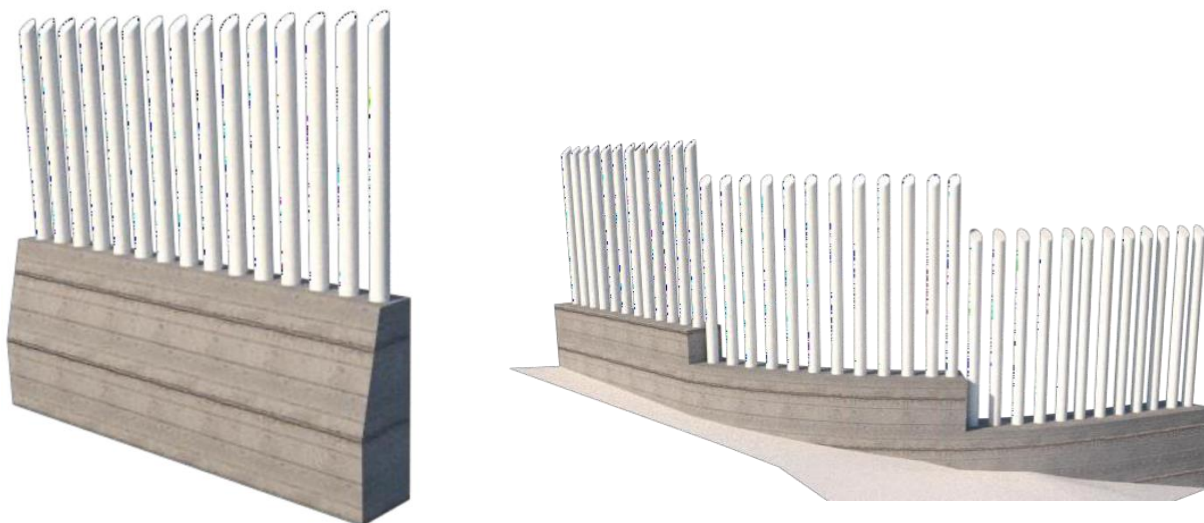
Perfil constructivo Calle 5 (tipología lineal) – Perfil Constructivo Carrera 37 (tipología escalonada)
